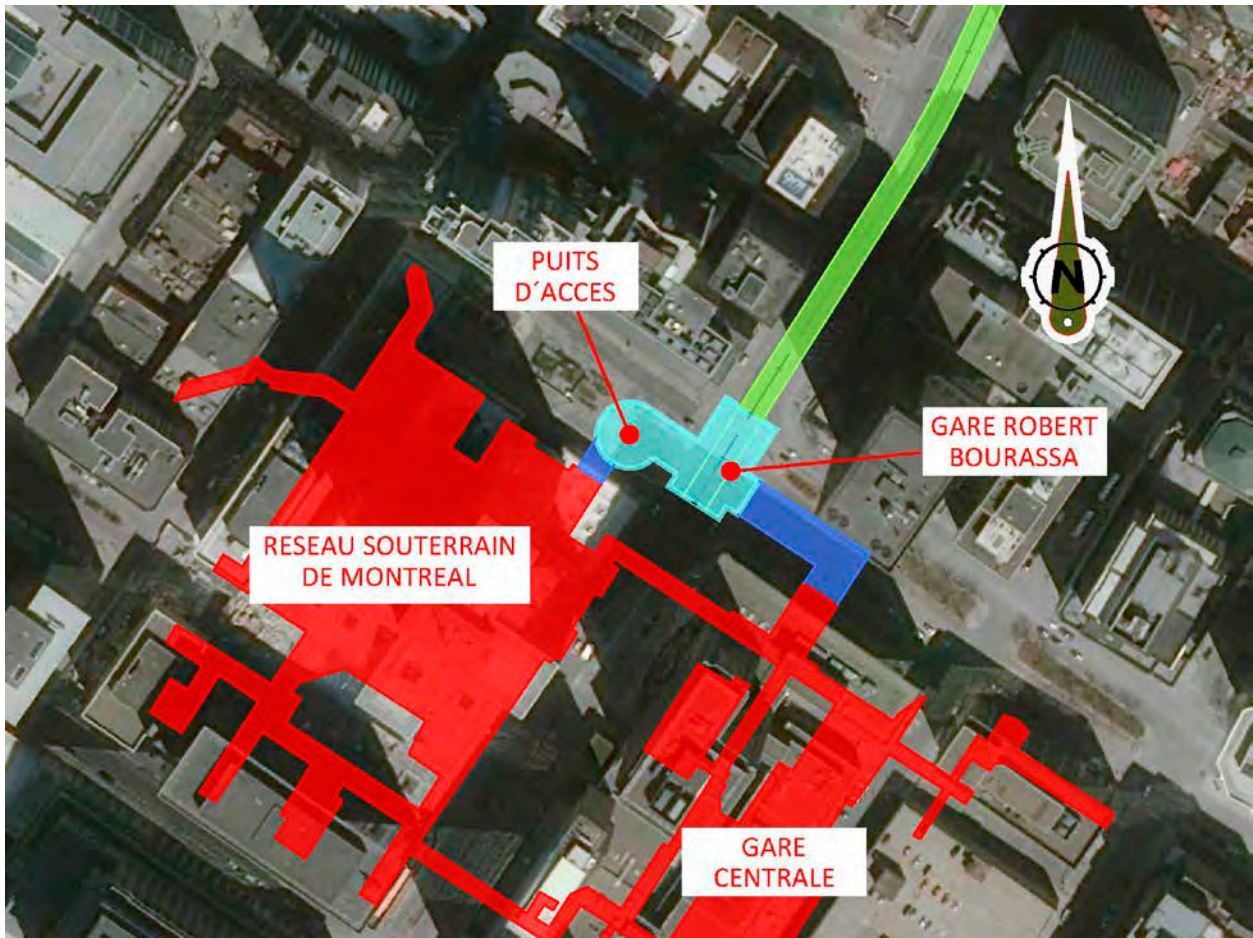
a.- Vue en plan de la gare Robert Bourassa.
